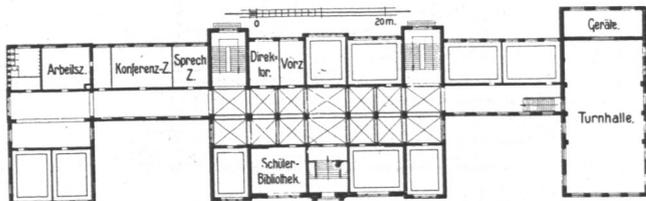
Realgymnasium Armgartstraße, Erdgeschoß.
